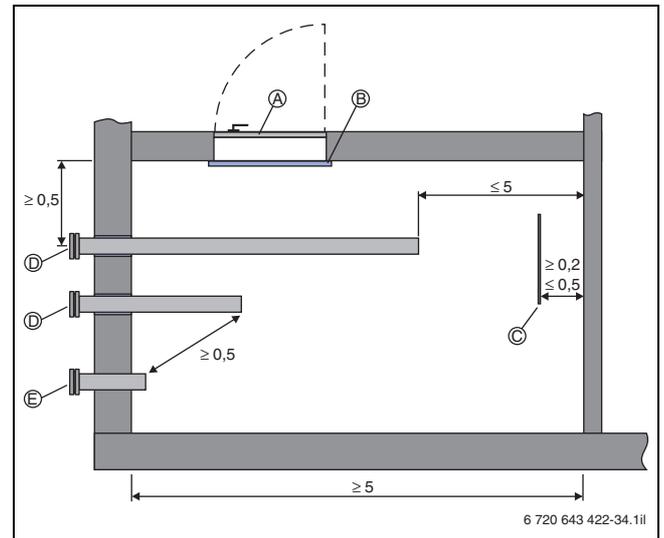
Schnitt (Draufsicht) durch ein Pelletlager mit Raumlänge  $\geq 5$  m (Maße in m)
